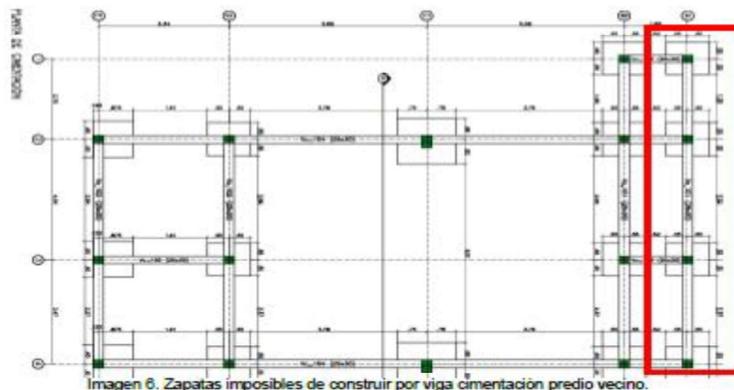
Zapatas imposibles de construir por viga cimentación predio vecino.
